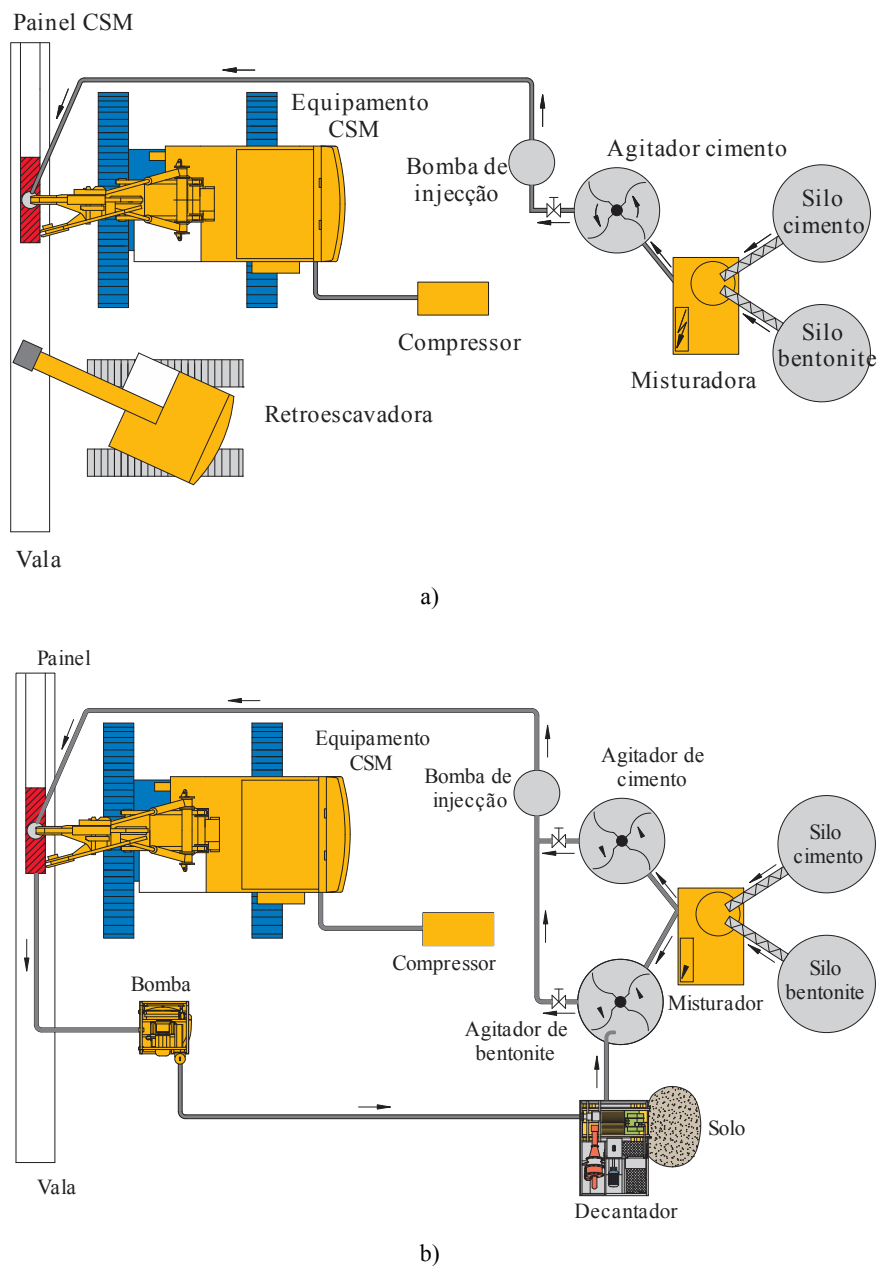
Plantas esquemáticas: a) sistema de fase única; b) sistema de duas fases (adaptado de Bauer, 2010)
